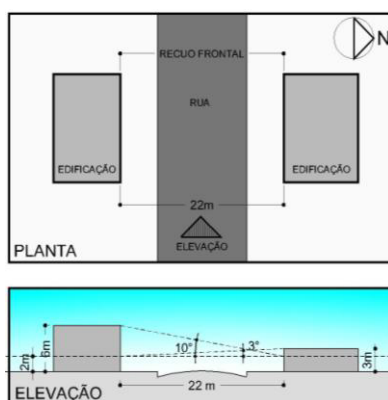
Ângulos de céu obstruídos para as fachadas Norte/ Sul - adensamento 01 (situação atual)
